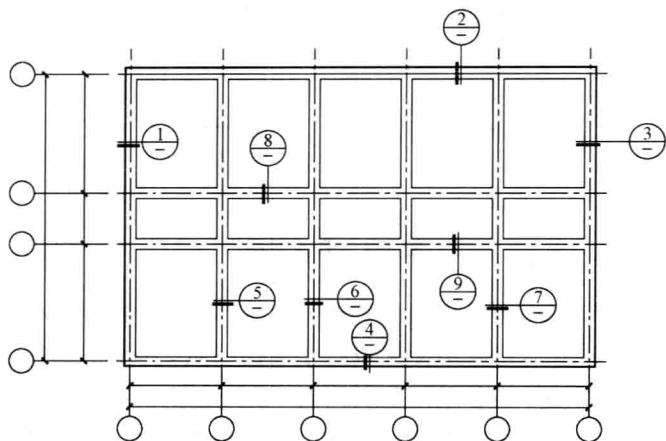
结构平面图中索引剖视图、断面详图编号顺序表示方法
